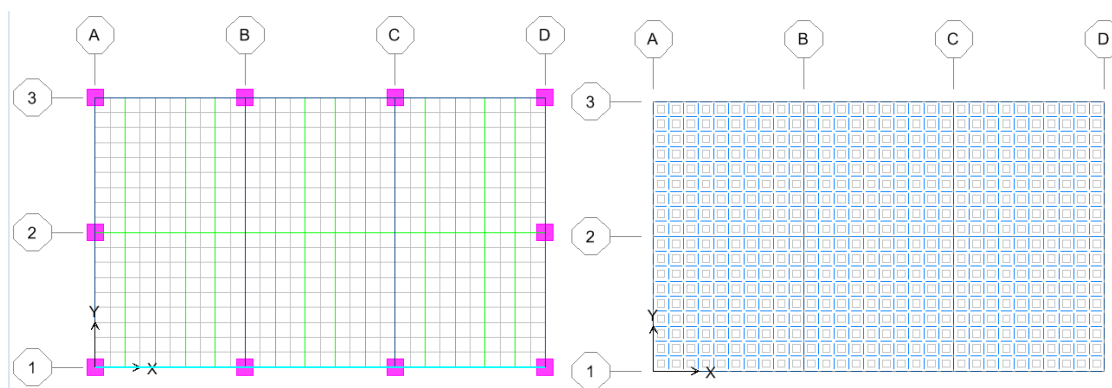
Sistema de piso Losa con vigas poco espaciadas (izquierda), Losa aligerada (derecha)
